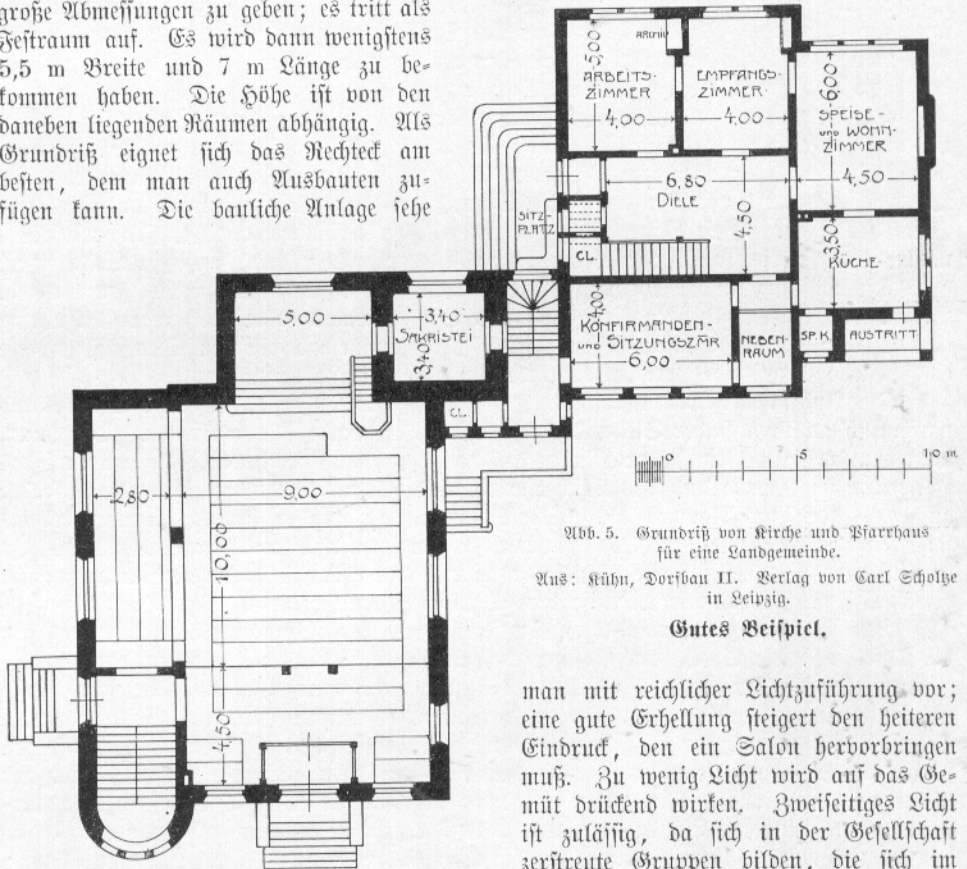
Grundriß von Kirche und Pfarrhaus für eine Landgemeinde.
